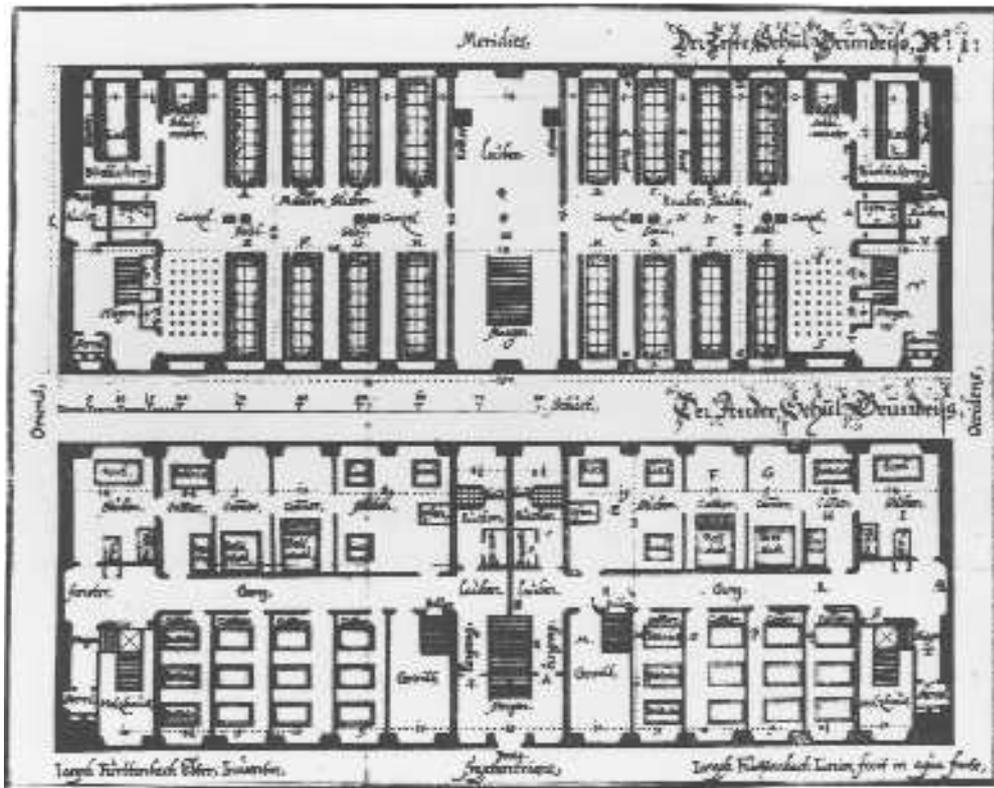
Furttendach d. J., Teutsches Schul-Gebaw, Grundriß, 1649
